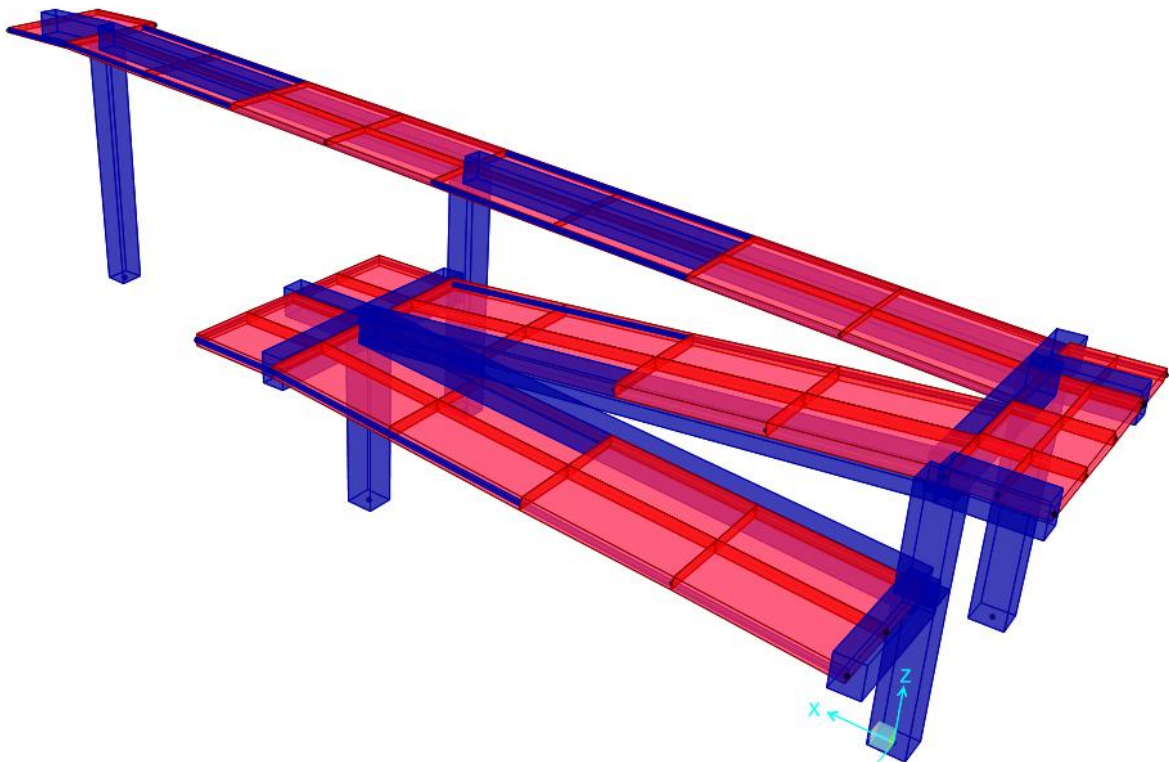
VISTA ESTRUCTURA RAMPA.
